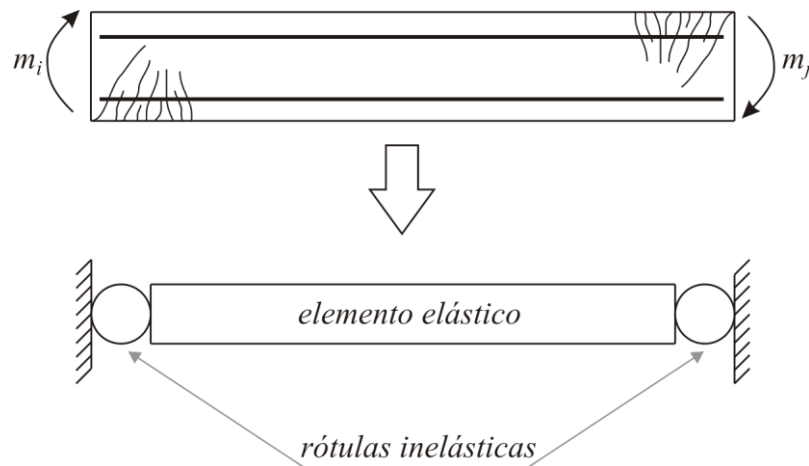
Elemento finito de concreto armado e respectivo modelo de dano concentrado.
